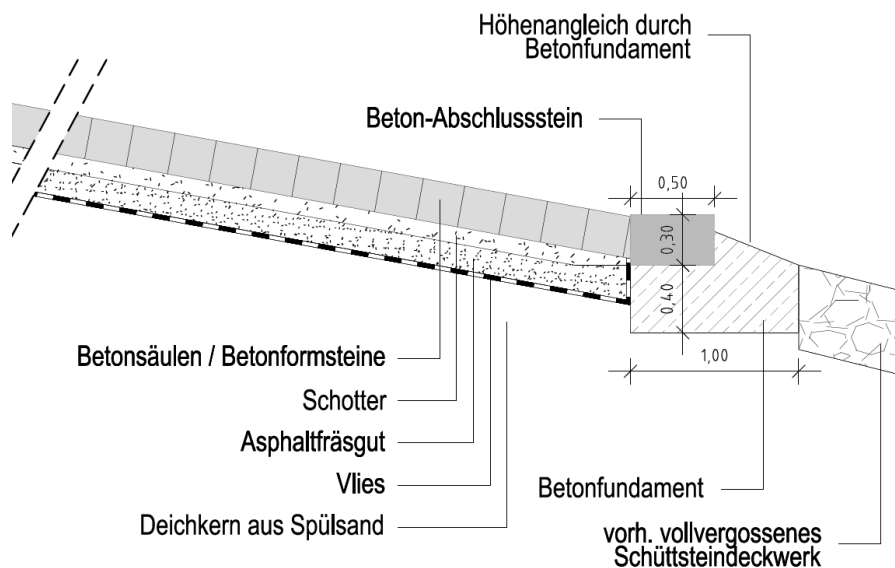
Querprofil Anschluss Außenböschung an vorhandenes Schüttsteindeckwerk
